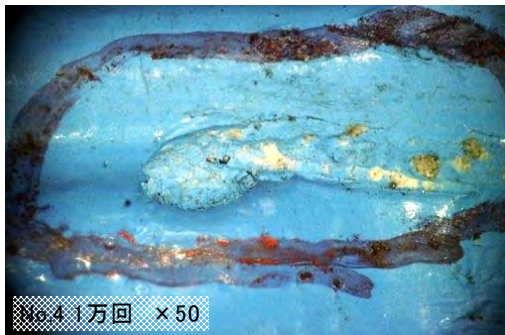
No. 4 位置損傷状況 (B014 試験体)
